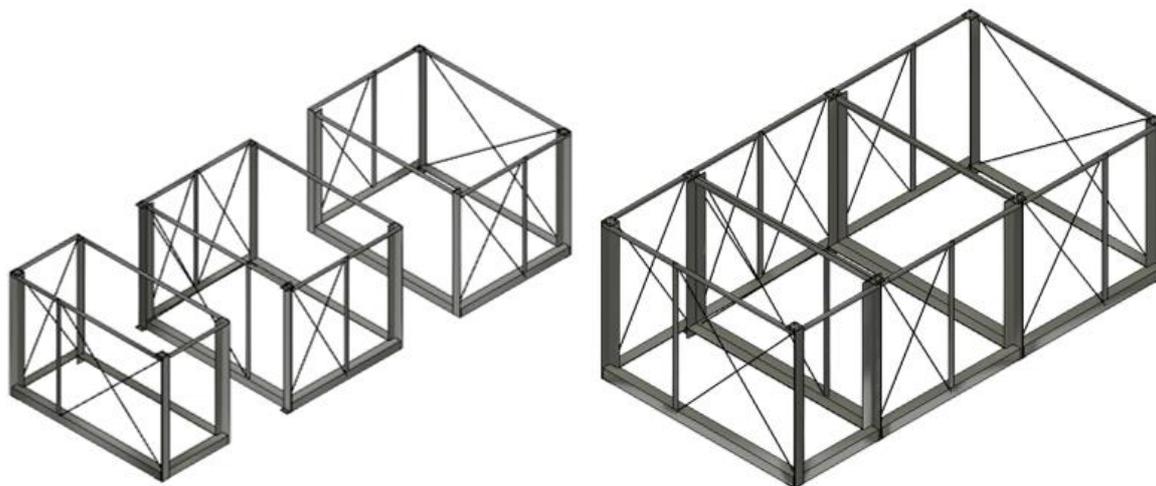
Módulo de suite seccionado (à esquerda) e módulo de suite assemblado (à direita)
